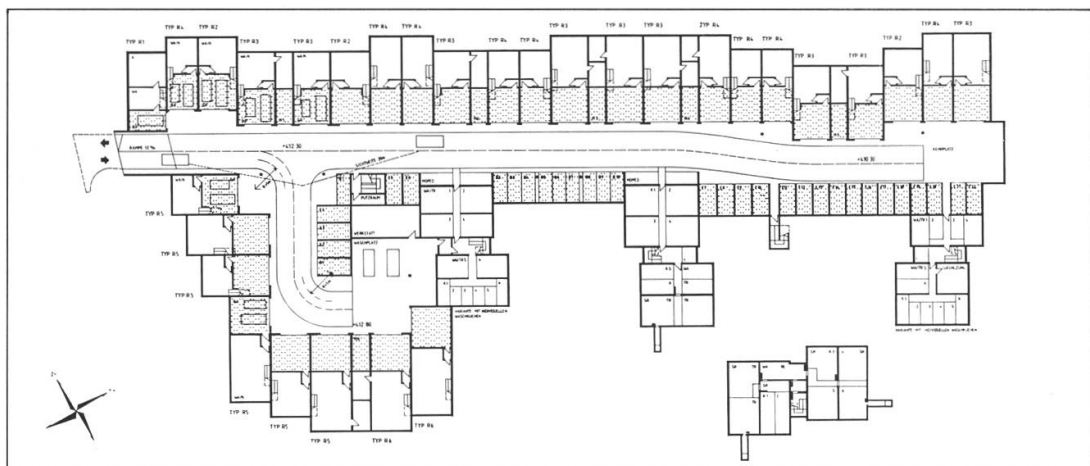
Grundriß Untergeschoß Vorprojekt 1:200
